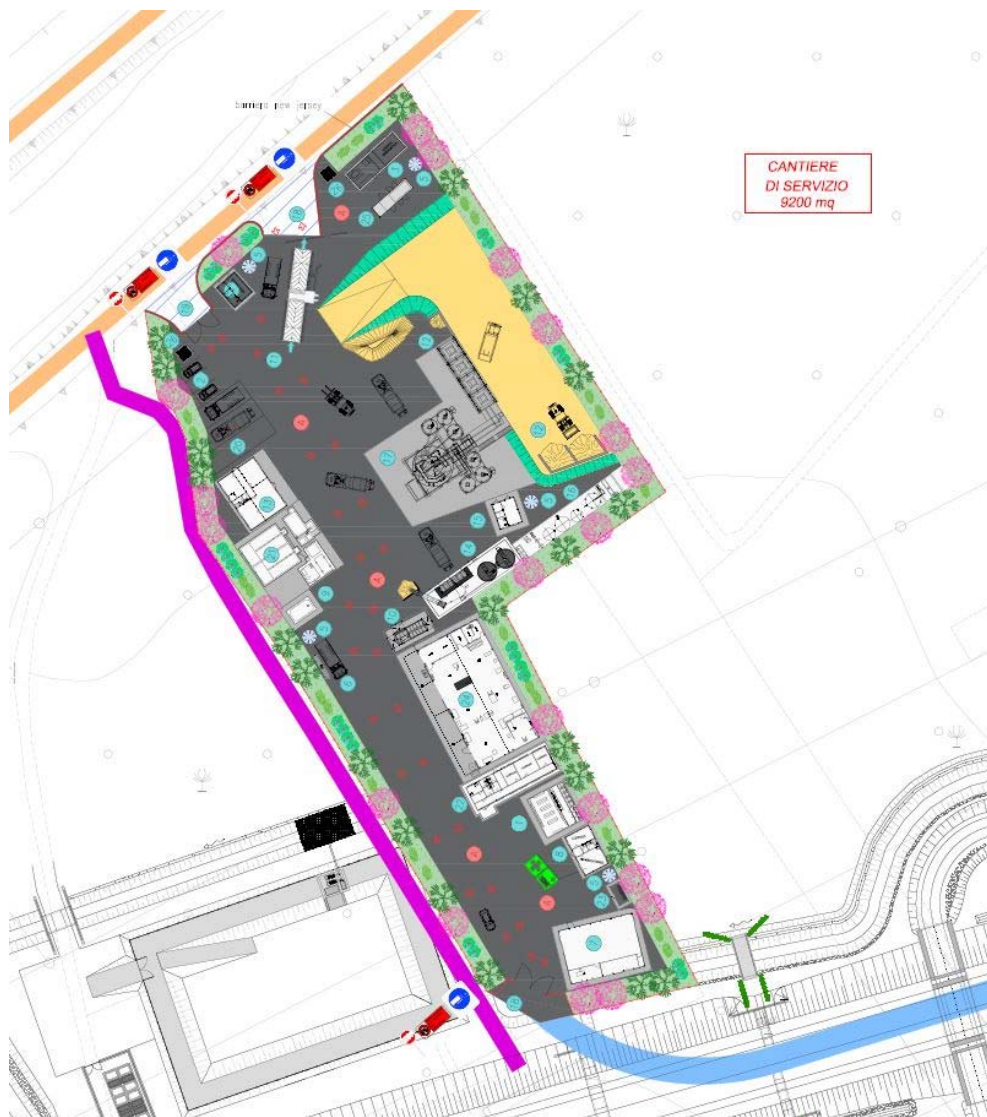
AREA CANTIERE DI SERVIZIO
